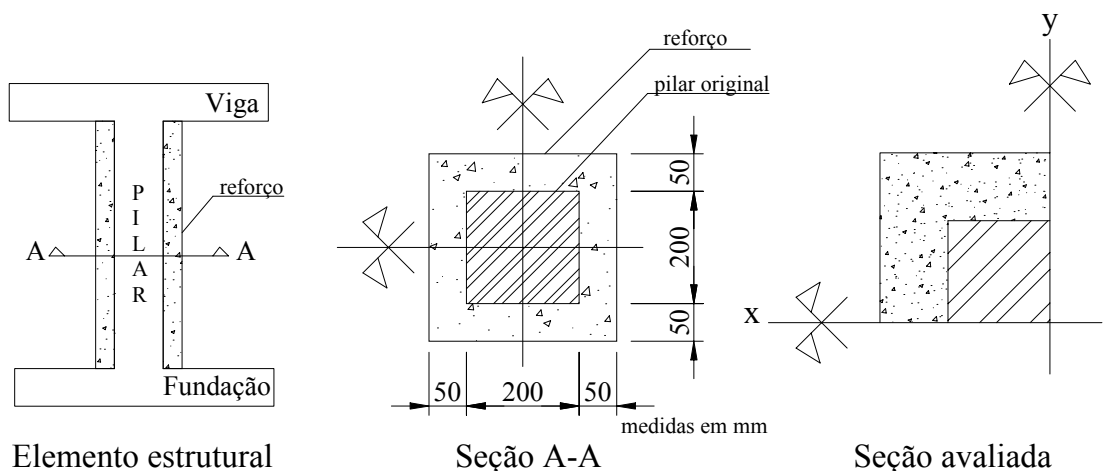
Situação do elemento estrutural reforçado - RAHMAN, BALUCH & AL-GADHIB (1999).
